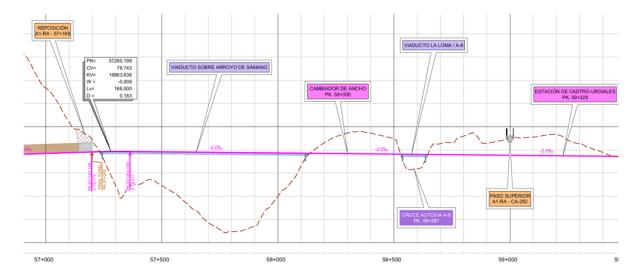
Perfil longitudinal Alternativa A1 rasante alta
